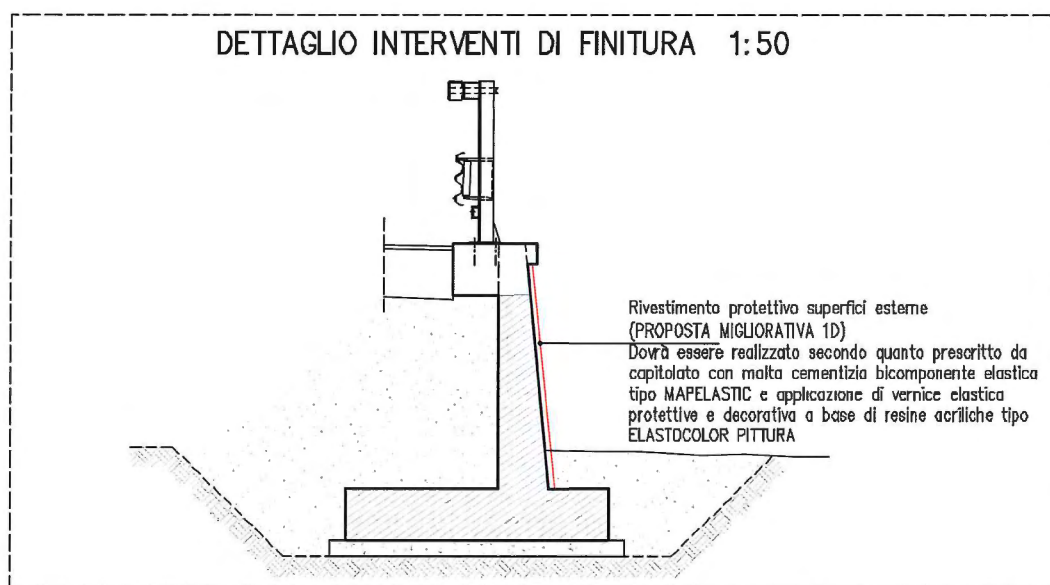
Sezione Tipo – Interventi migliorativi
